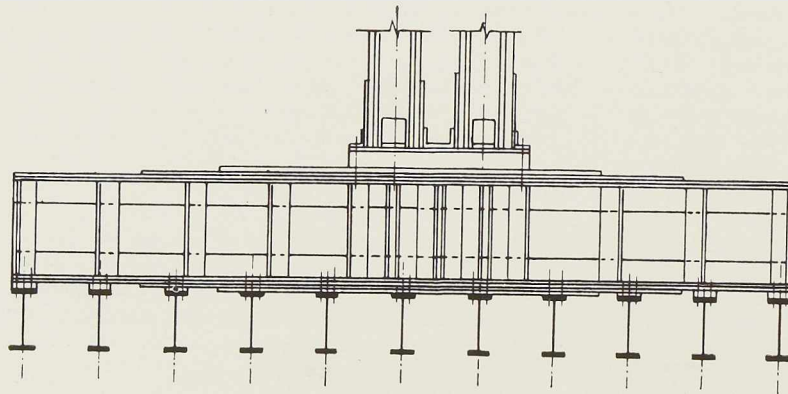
Coupe dans un grillage montrant les deux rangées de poutres en acier. Les poutres inférieures ont 450 mm de hauteur.
